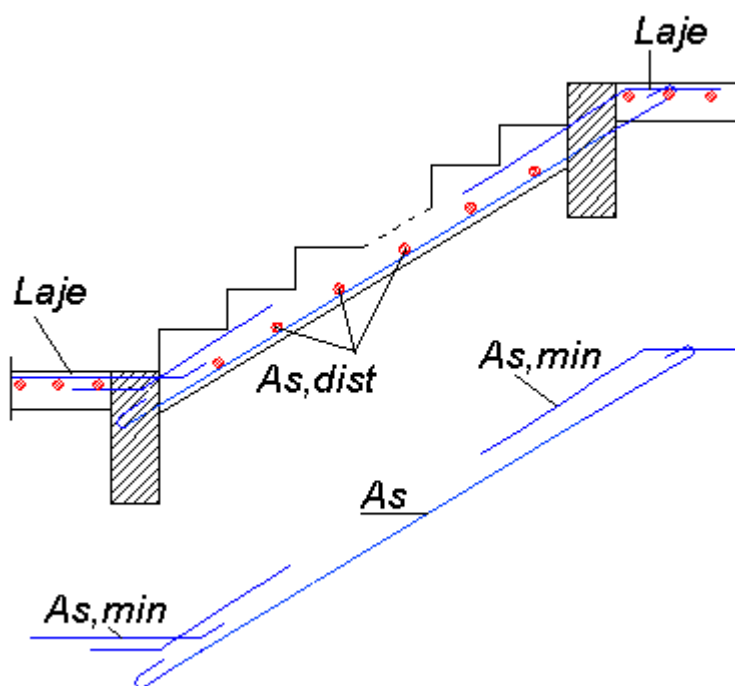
detalhe de um lance apoiado sobre vigas e lajes com pequeno engastamento (adaptado de ARAÚJO, 2003a, p. 68)
